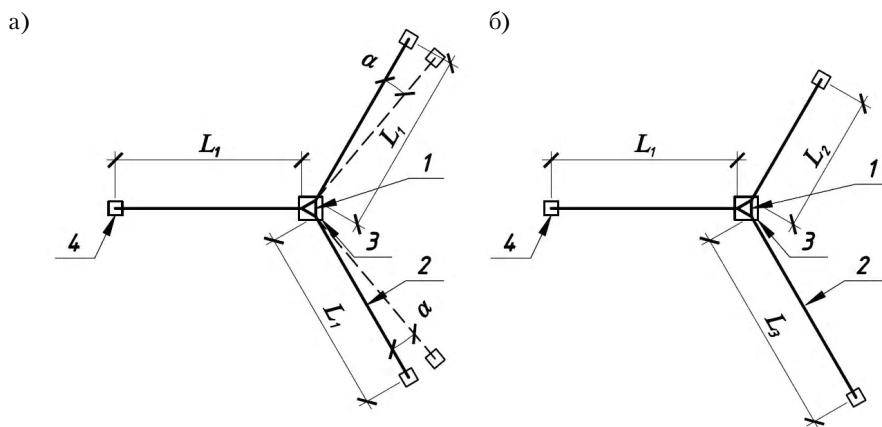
Схемы оттяжек: а) равной длины; б) неравной длины; 1 – ствол; 2 – оттяжка; 3 – центральный фундамент ствола; 4 – анкерный фундамент оттяжек; α – угол отклонения оттяжки от проектной оси.
